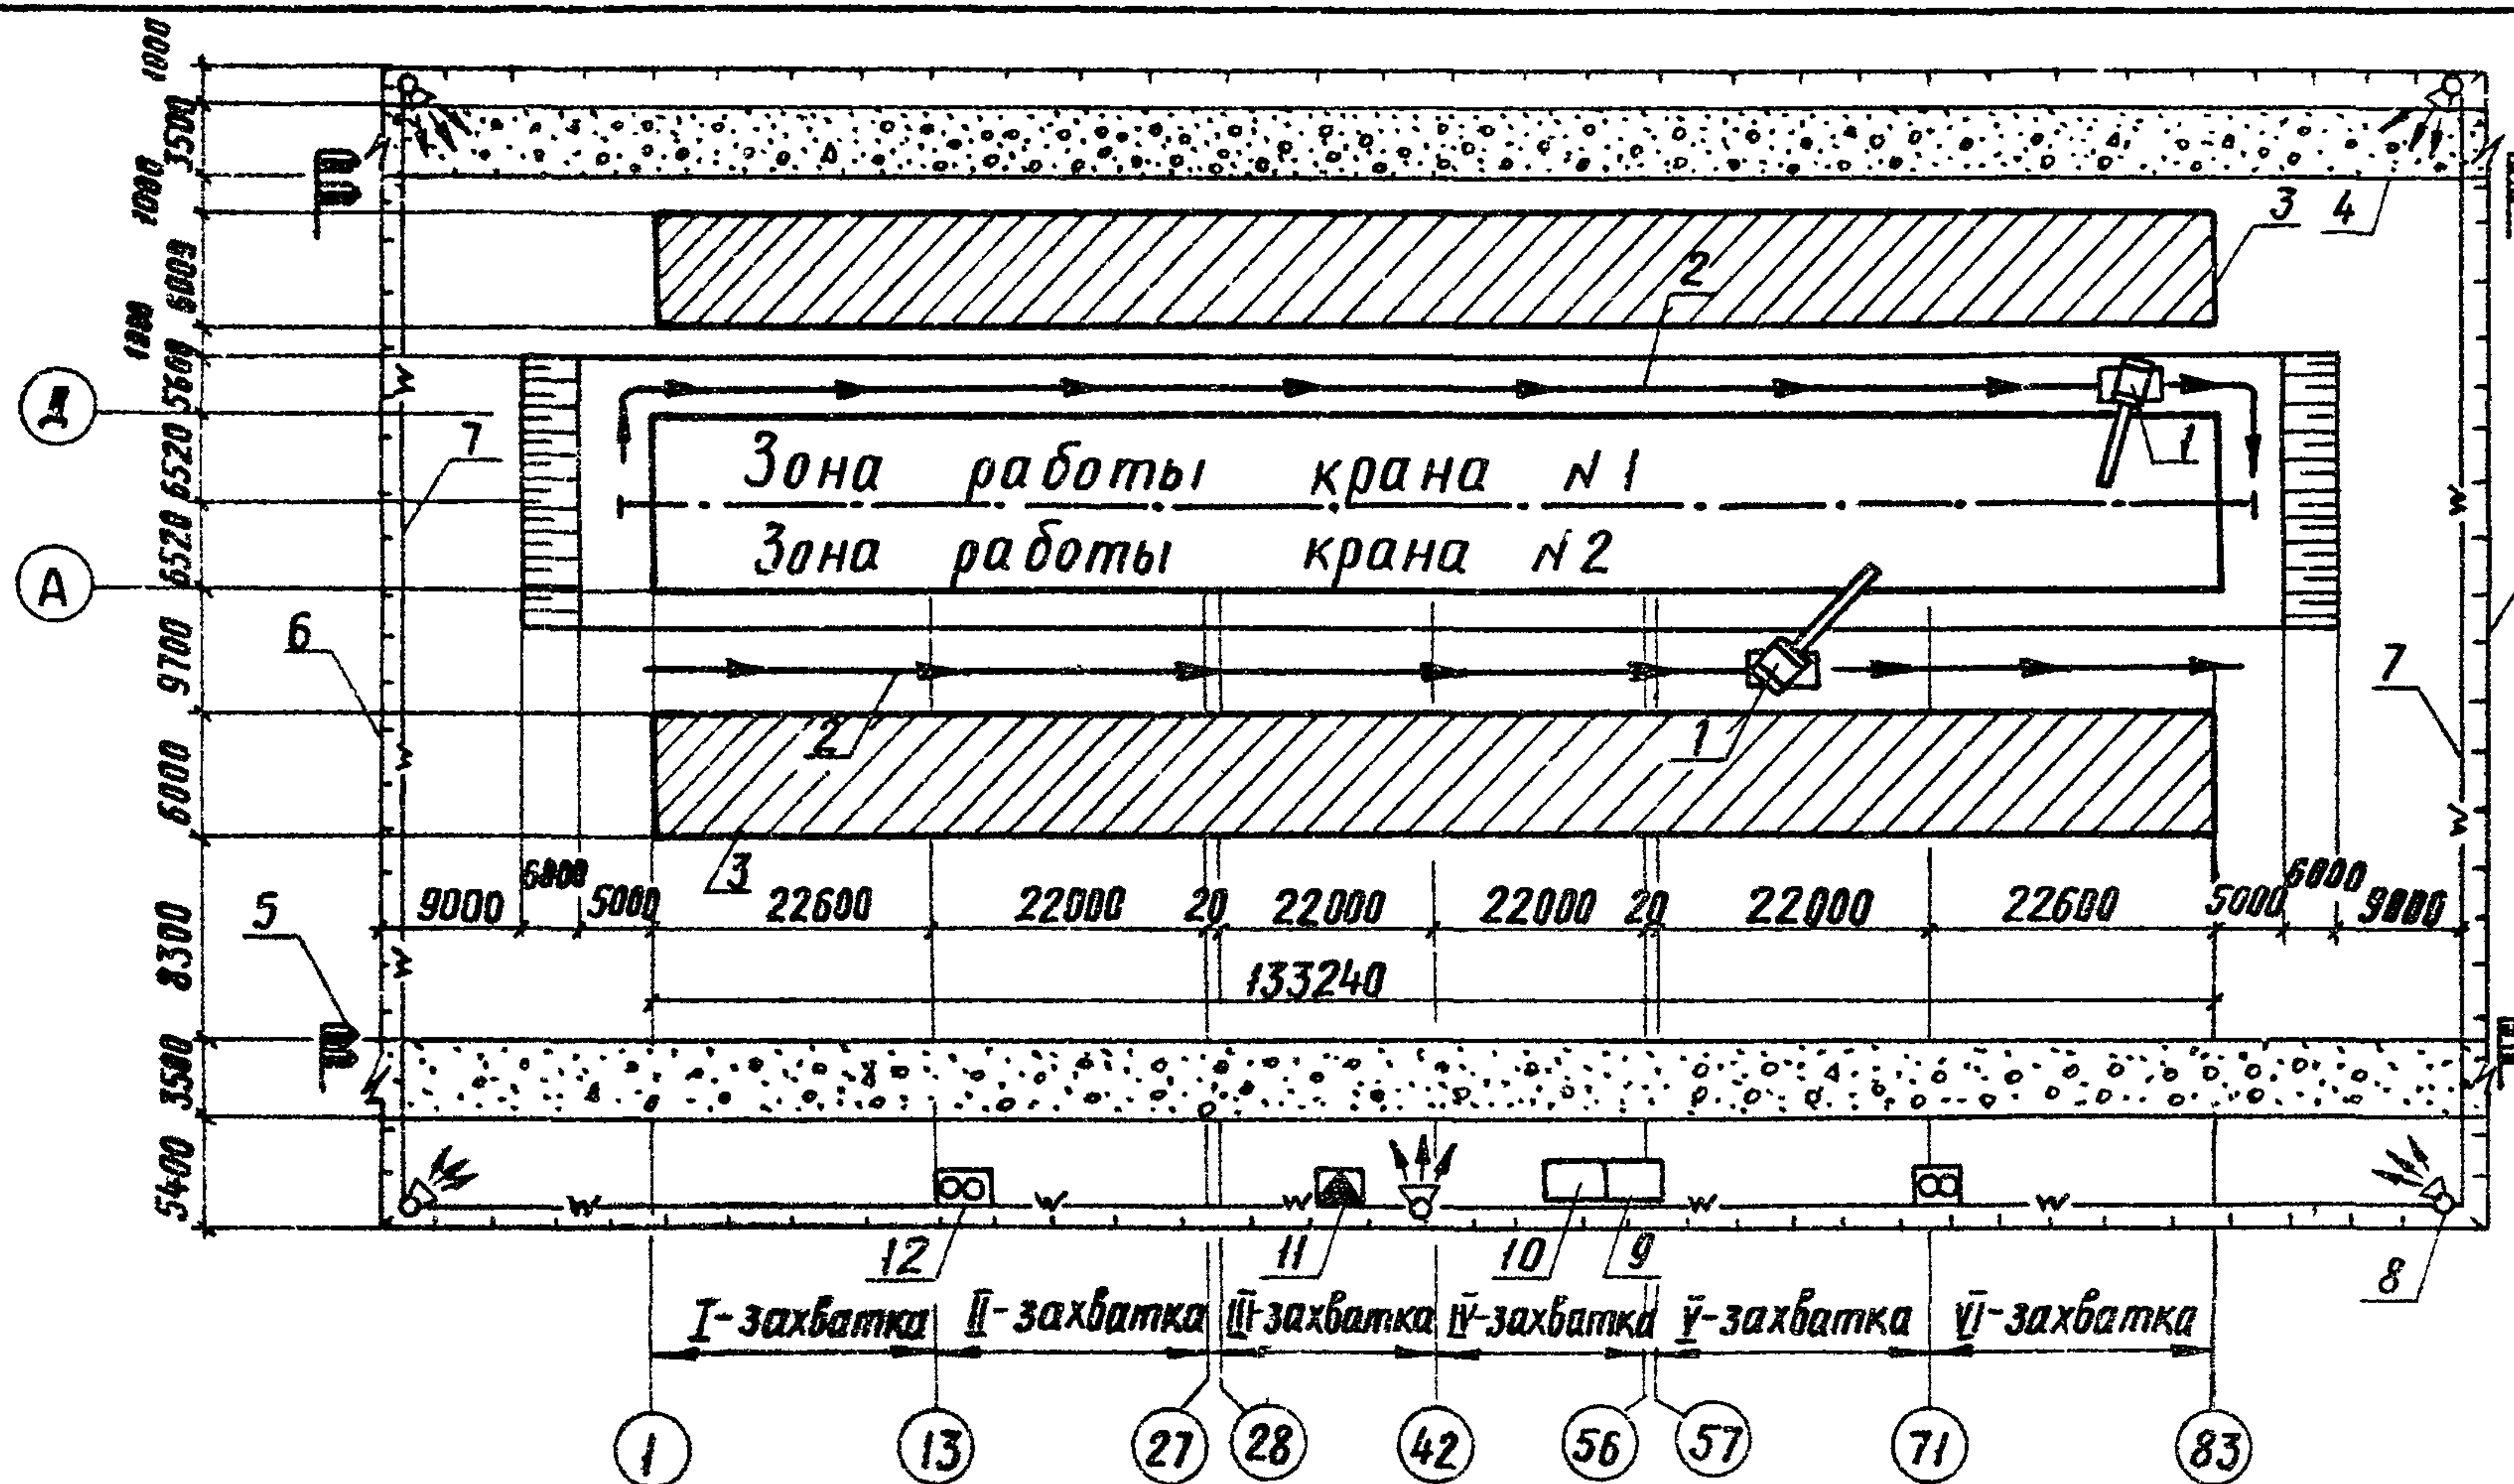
Схема организации строительной площадки: 1-краны К-161; 2-оси проходов кранов; 3-площадки складирования материалов и конструкций; 4-временный проезд; 5-знаки: "Берегись автомобиля" и "Посторонним вход воспрещен"; 6-временное ограждение; 7-кабель 380В; 8-проекторная мачта; 9-бытовое помещение; 10-контора производителя работ; 11-трансформаторная подстанция КТПН-180; 12-туалет
